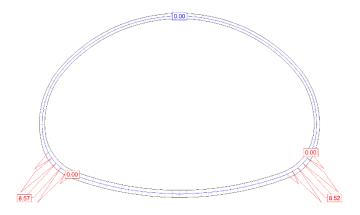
Secção TT.3. Armaduras de cálculo de flexão (cm2/m)
